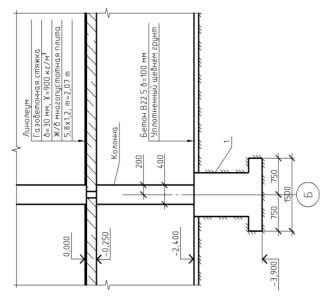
Пример оформления поперечного разреза отдельного фундамента мелкого заложения
